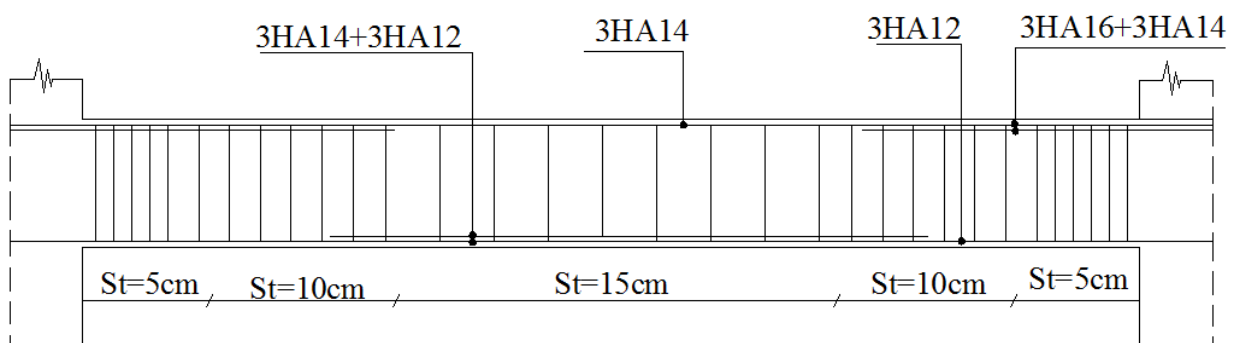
Ferrailage des poutres de l'étage 5, 6,7et 9
